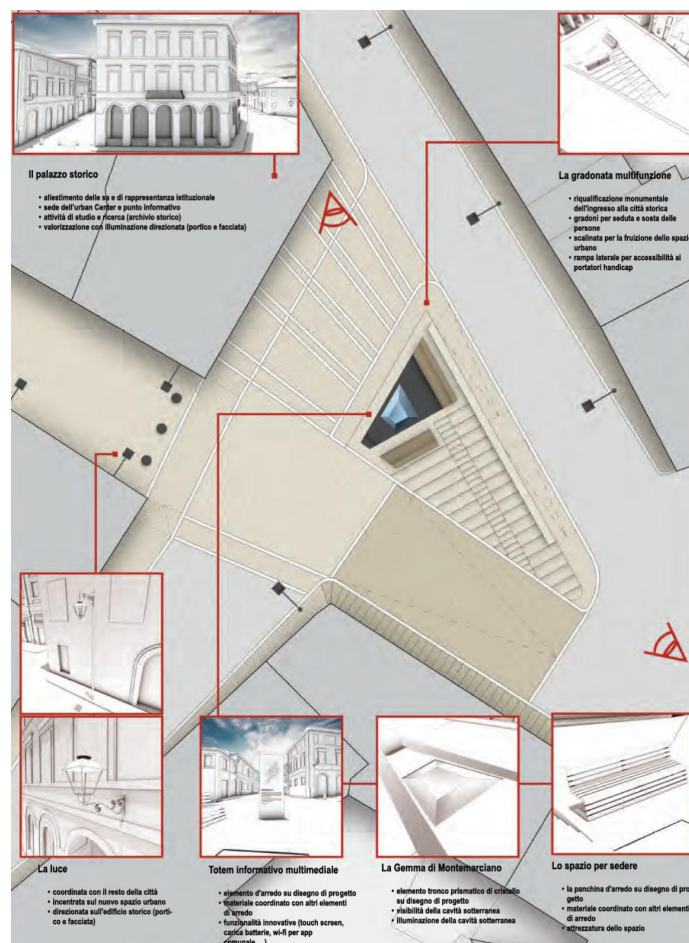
| Il Progetto Pilota nel piano urbanistico (Progettista capogruppo arch. R. Angelini)
